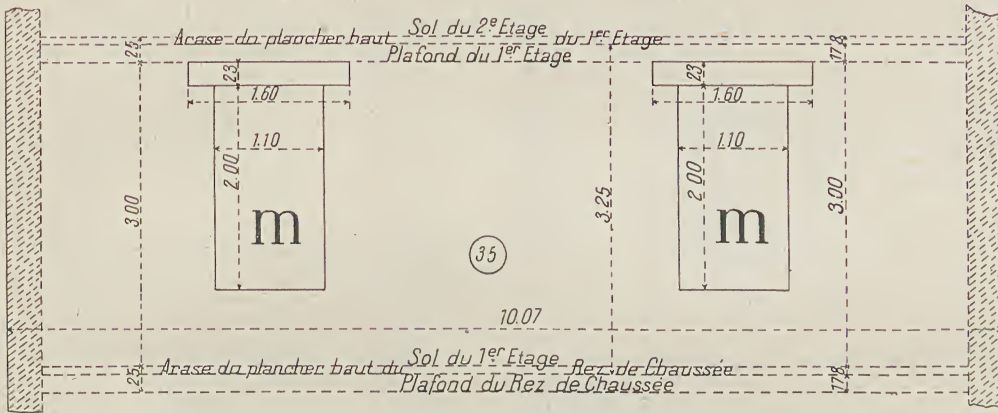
Façade latérale de droite ; élévation vue du côté du jardin.
